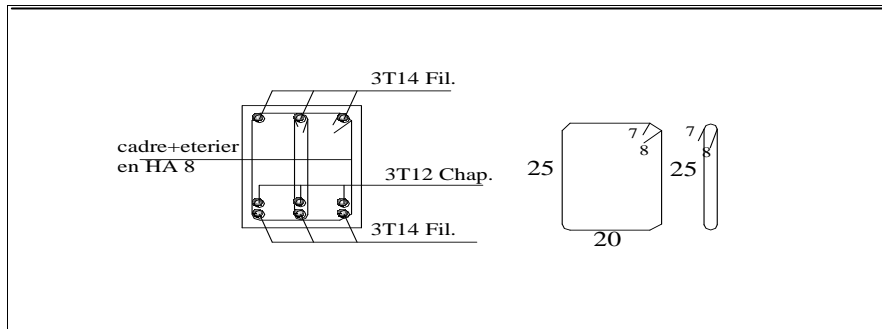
Ferrailage en travée d’une poutre principale PP1 sur appuis.
